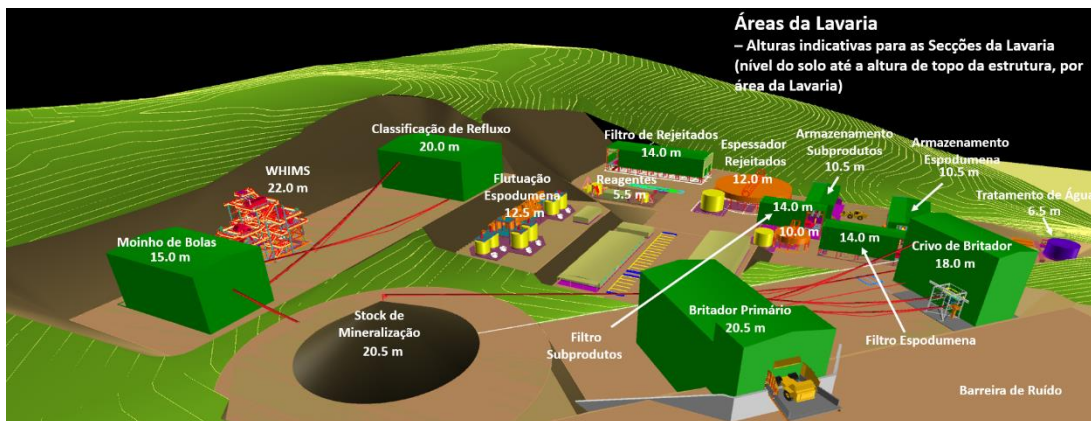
Imagem 3D da unidade de processamento vista para Sul (no local da Opção 2) com alturas de construção.
